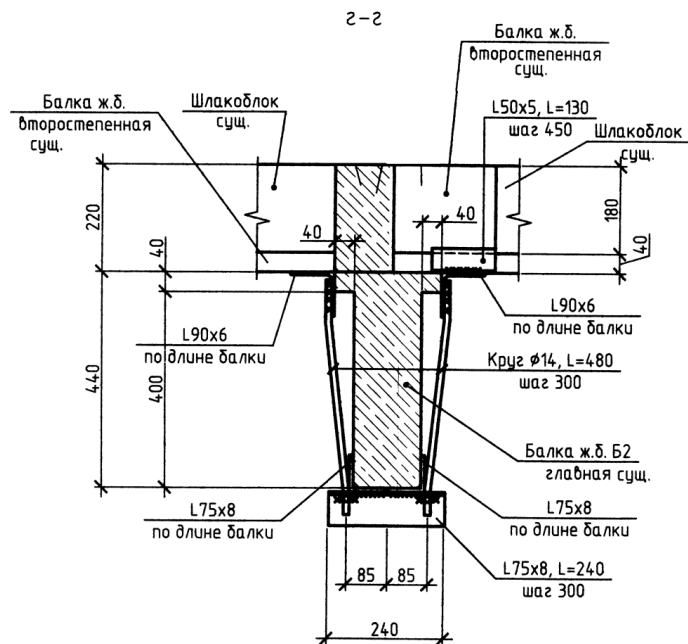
Усиленная балка перекрытий Б-2 в осях 13-17/Г-Ж согласно рабочей документации
